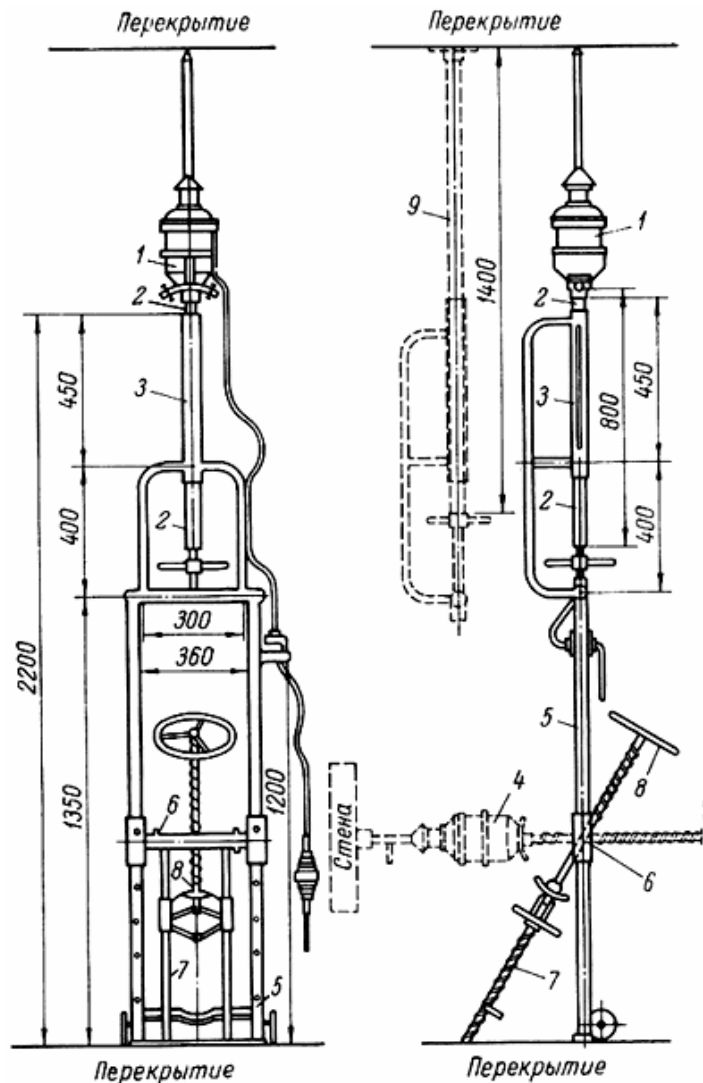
Станок-стойка для сверления отверстий в полах, потолках и стенах
